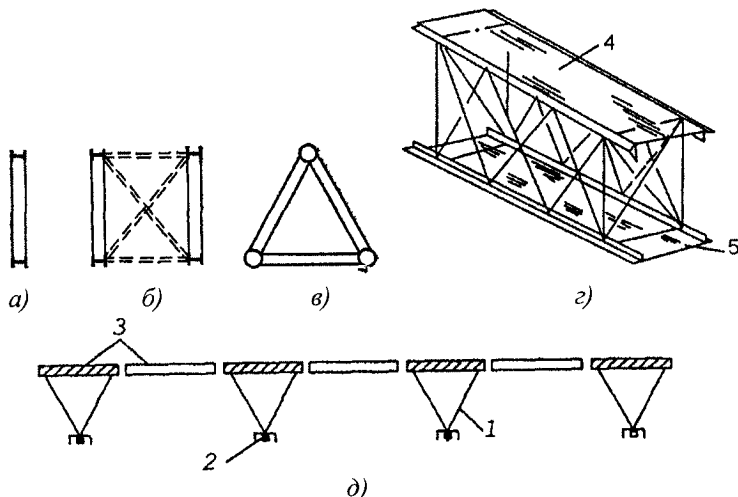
Конструктивні форми ферм: а – плоска; б – блокова прямокутна; в – тригранна; г – блоково-балкова конструкція; д – з включенням до складу стиснутого пояса плит покриття; 1 – тригранна ферма; 2 – затяжка; 3 – плити покриття; 4 – попередньо напружена сталеві обшивка; 5 – ненапружена сталеві обшивка
